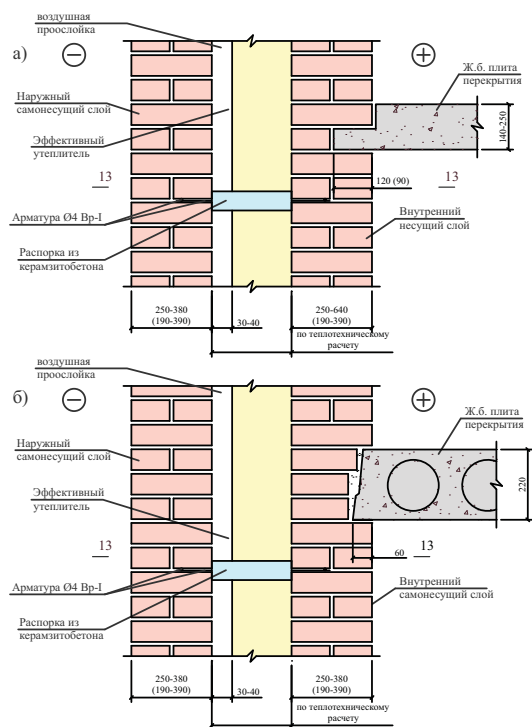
Наружная стена для зданий высотой до 18 этажей с самонесущим наружным слоем из кирпича или керамических камней толщиной 25-30 см на гибких связях (тип ГН-2): а – с несущим внутренним слоем; б – с самонесущим внутренним слоем
